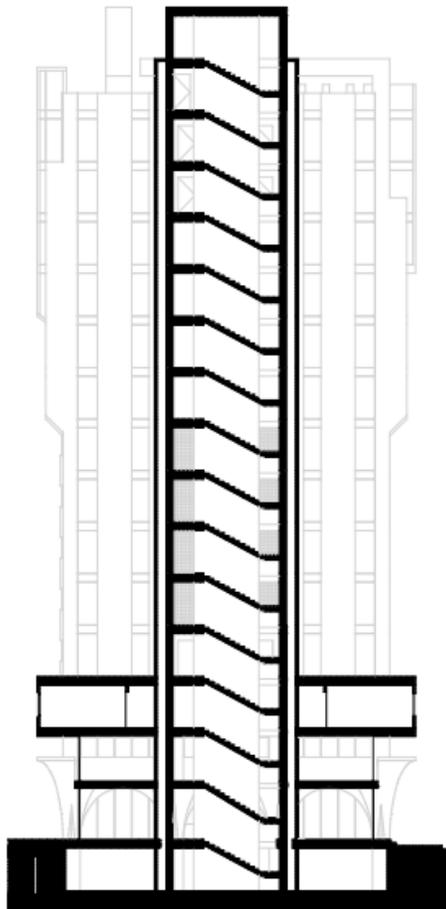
Sección transversal planificada. Fuente: Tesistas.
